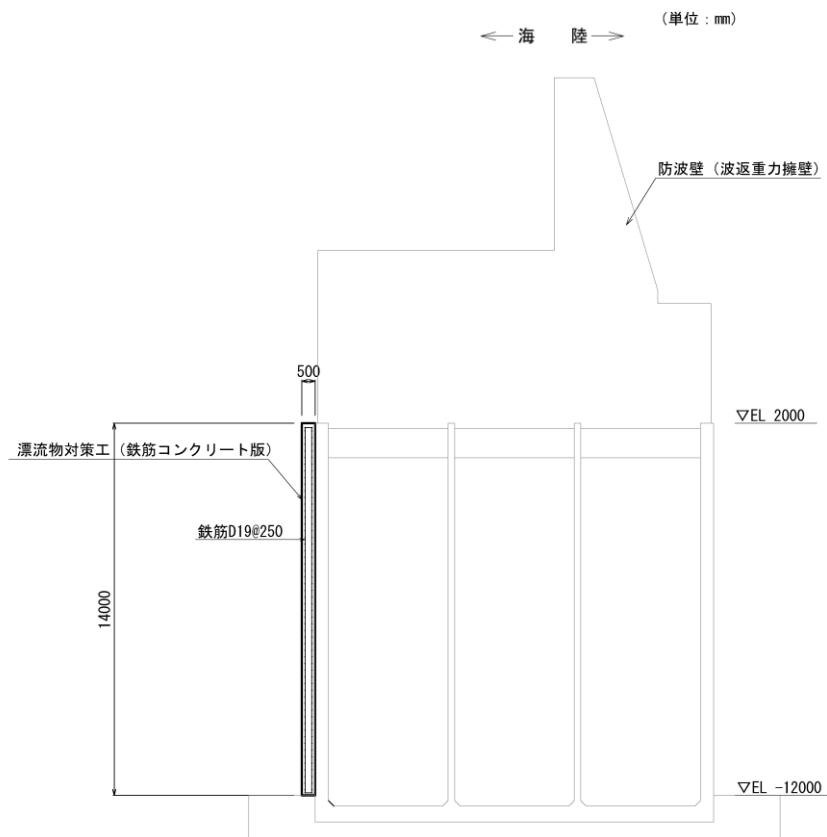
(4) 防波壁（波返重力擁壁）ケーソンにおける漂流物対策工（鉄筋コンクリート版）の概略配筋図（断面図）
